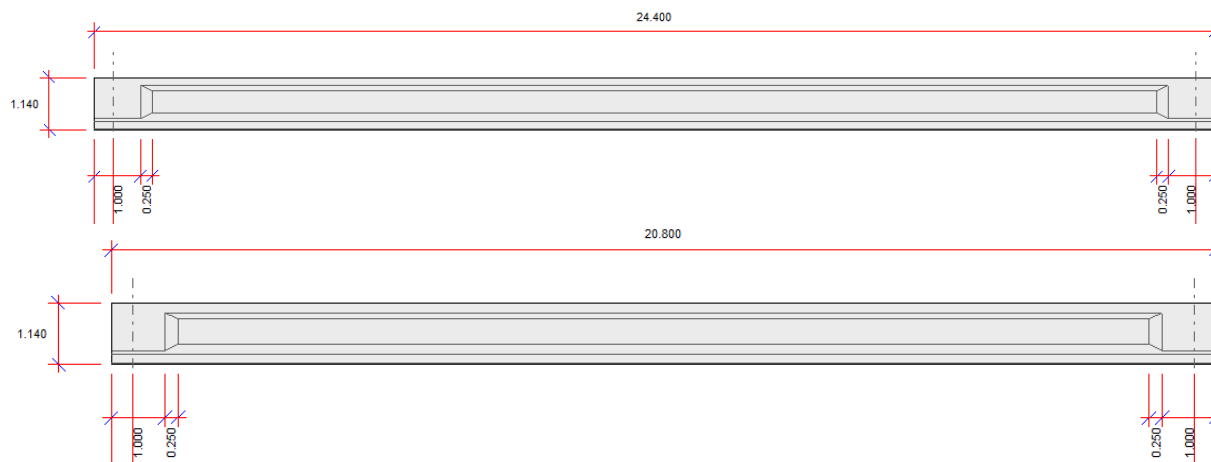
Alzado de vigas. Fuente: IDOM-DEHC.
